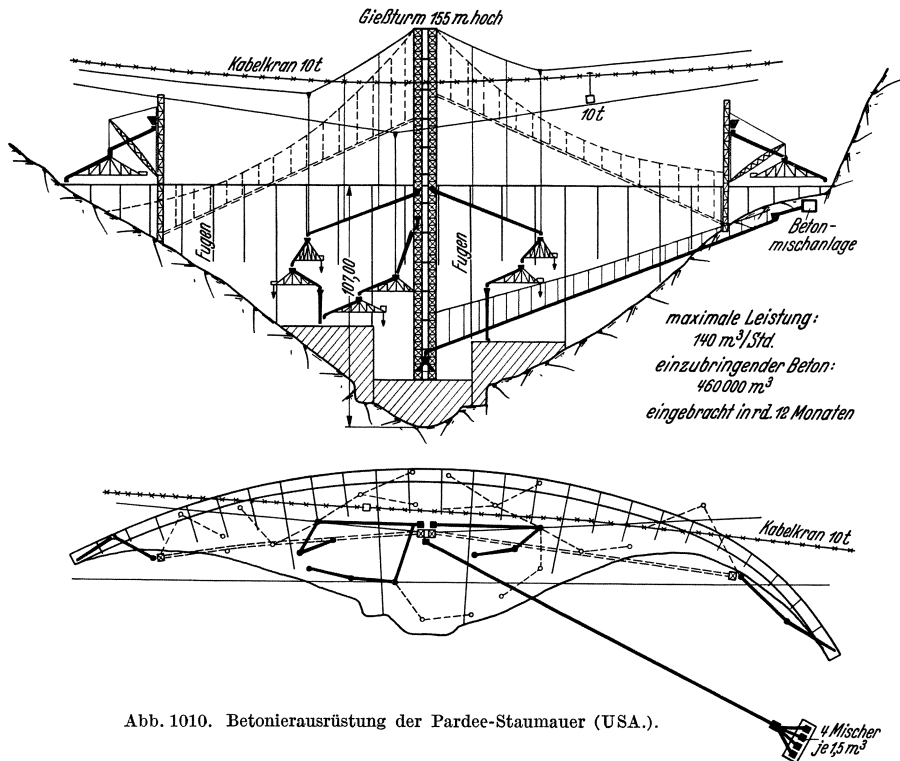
Betonierausrüstung der Pardee-Staumauer (USA.).
